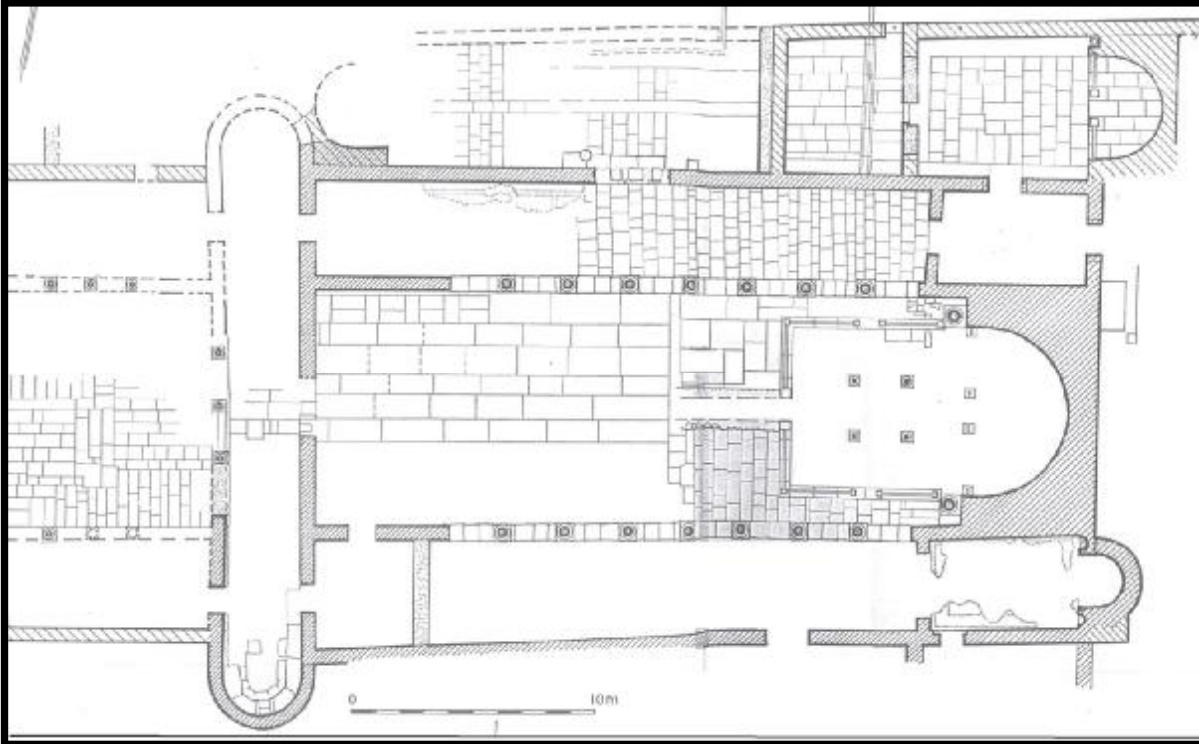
مسقط أفقي لمبنى الكنيسة الشرقية
